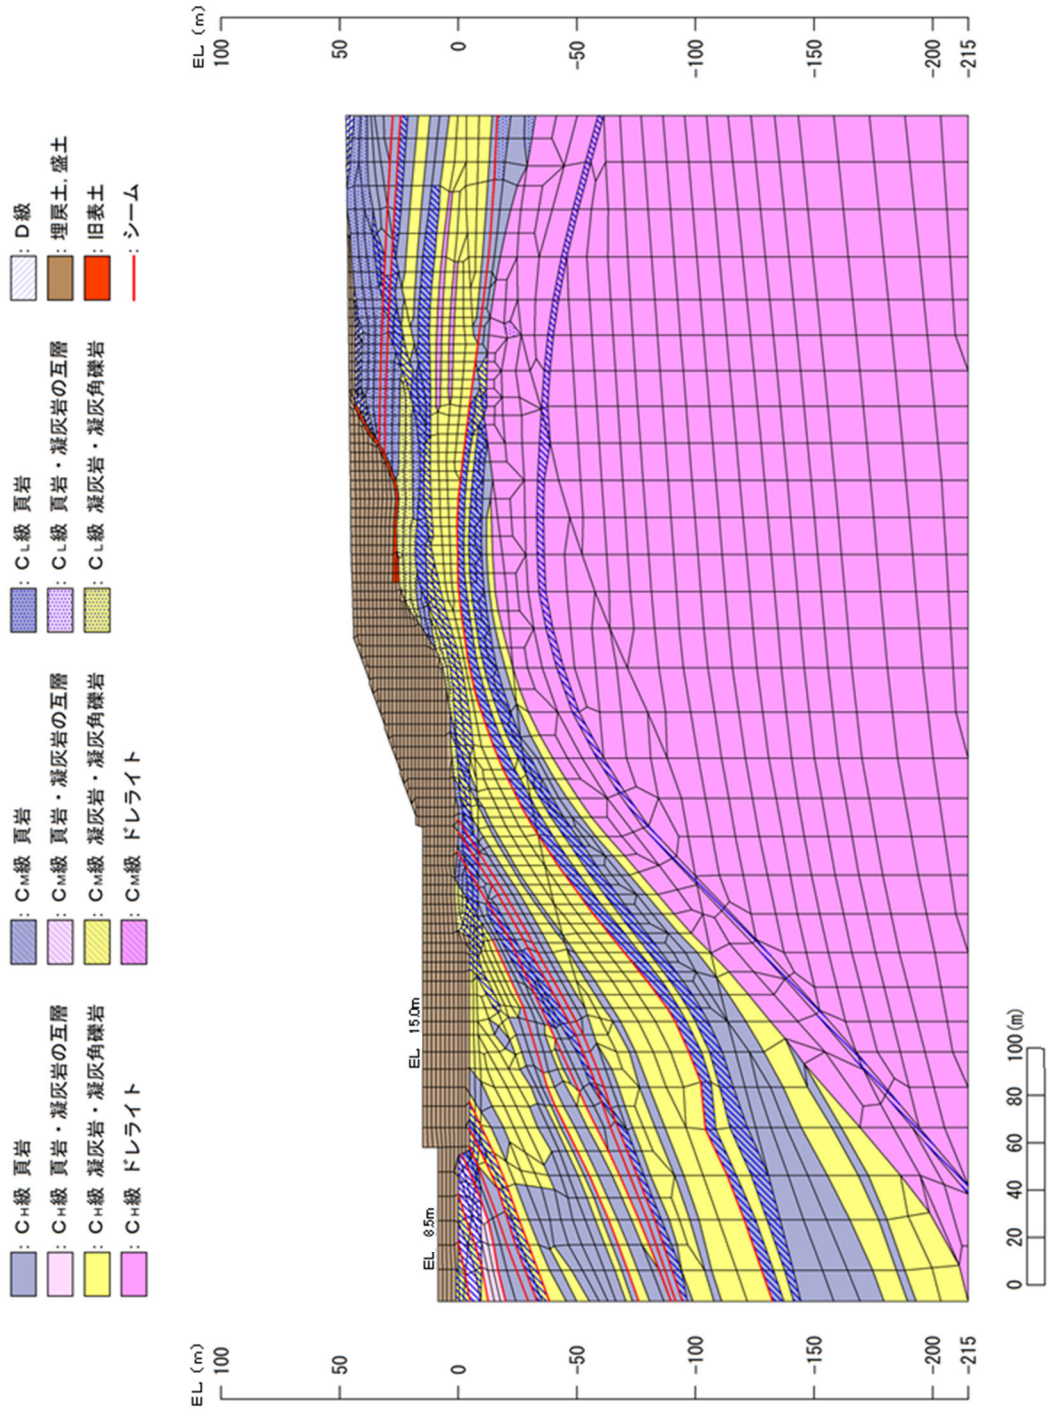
解析モデル図 (⑧-⑧' 断面)
